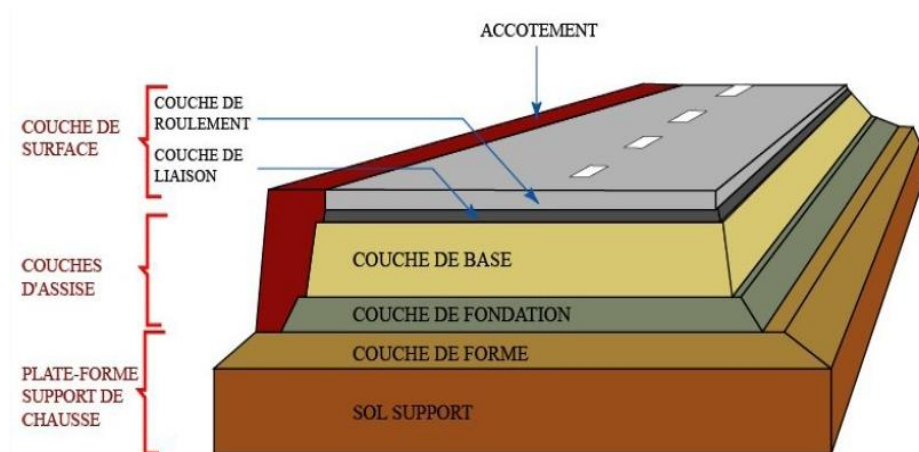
Coupe transversale schématique de la chaussée [43].
